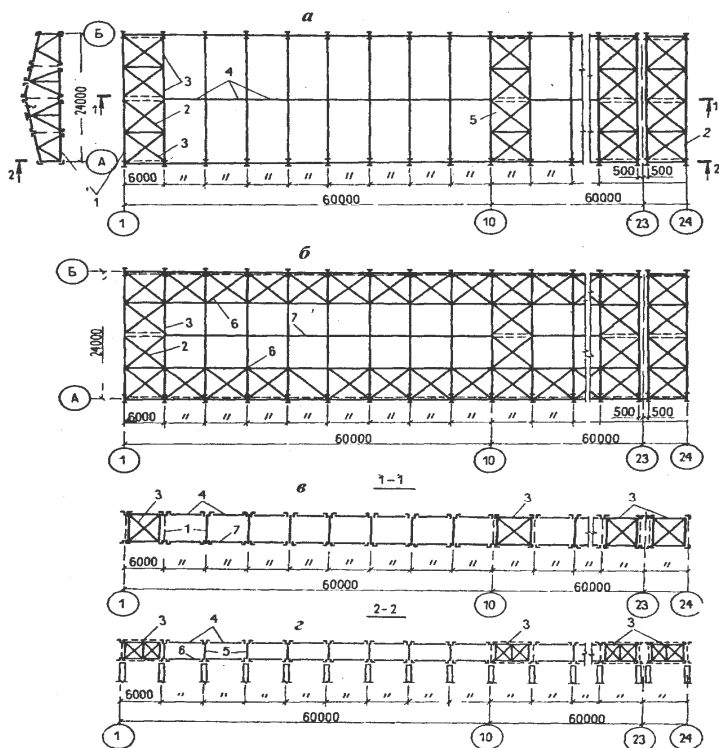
Установка связей в покрытии (шатре) стального каркаса:
